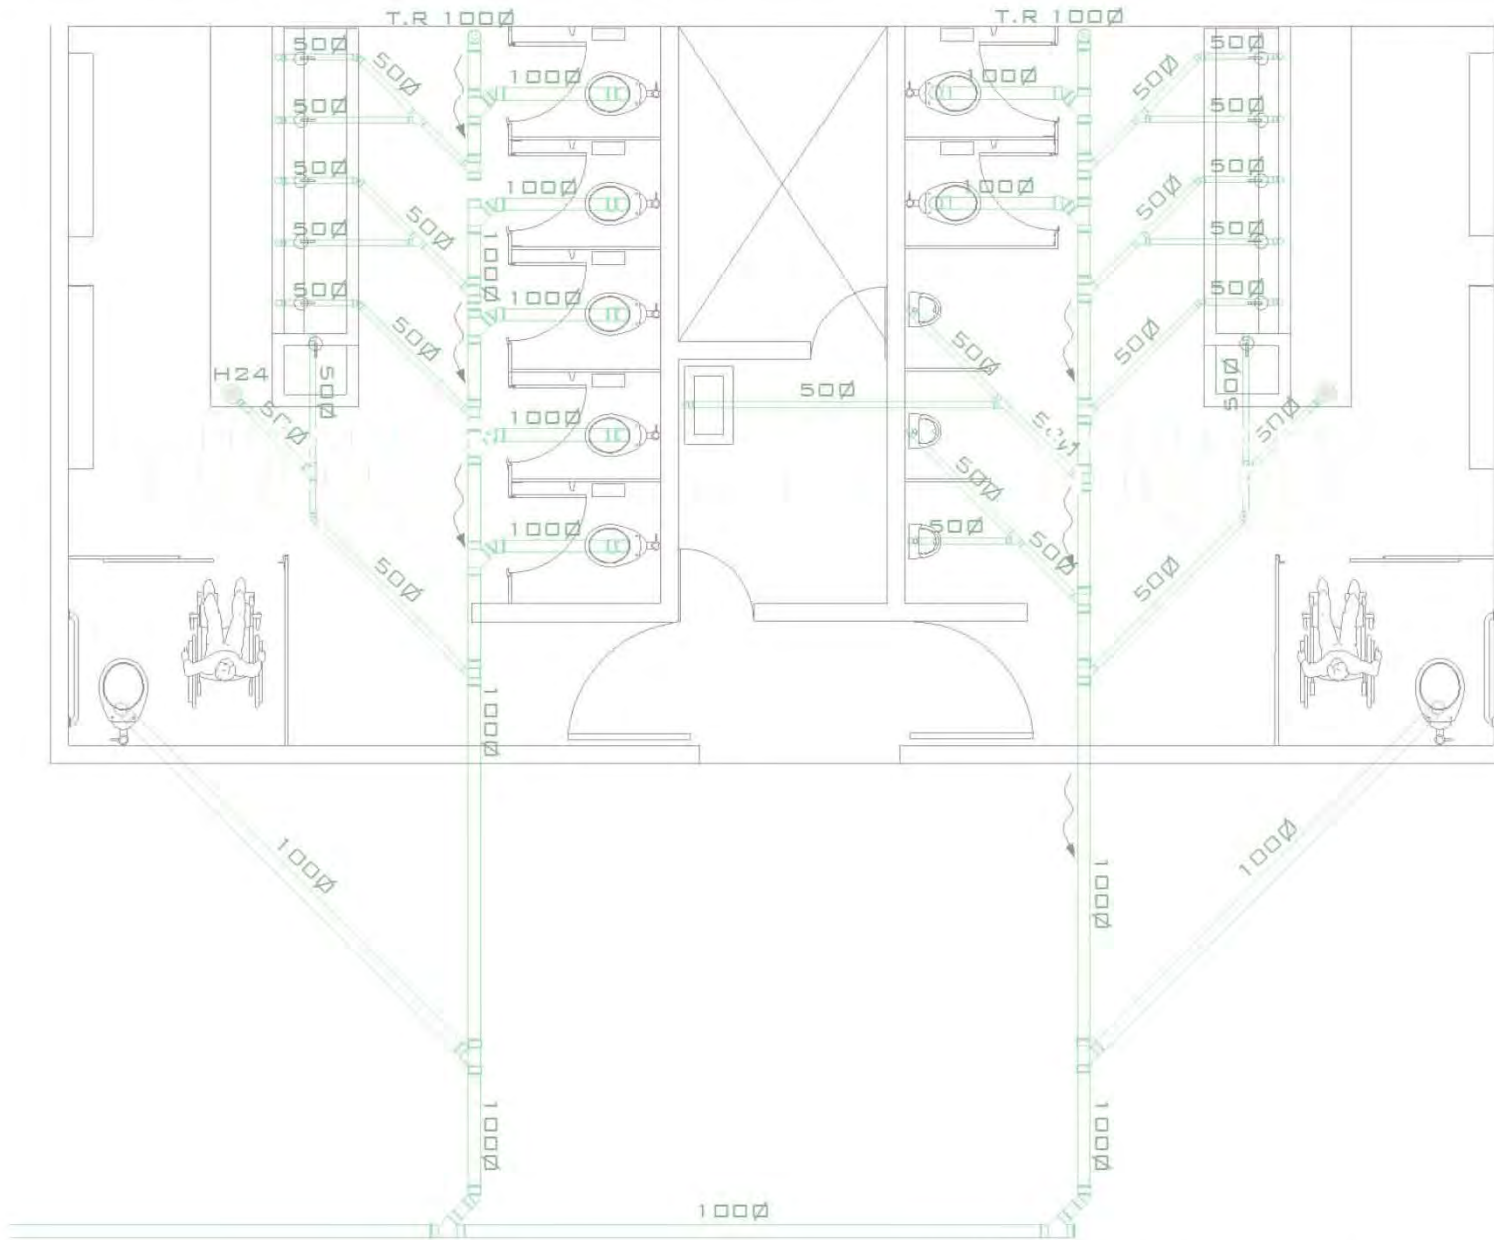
Instalación sanitaria en planta alta de CETRAM.
